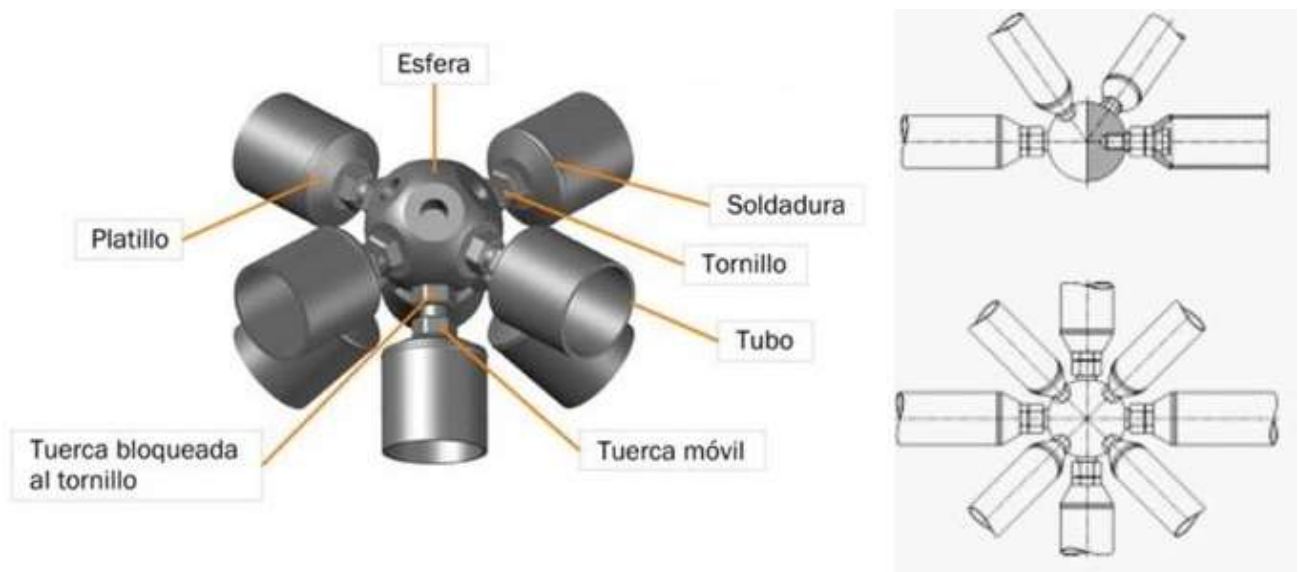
Detalle de articulación entre barras ⁽¹²⁾
